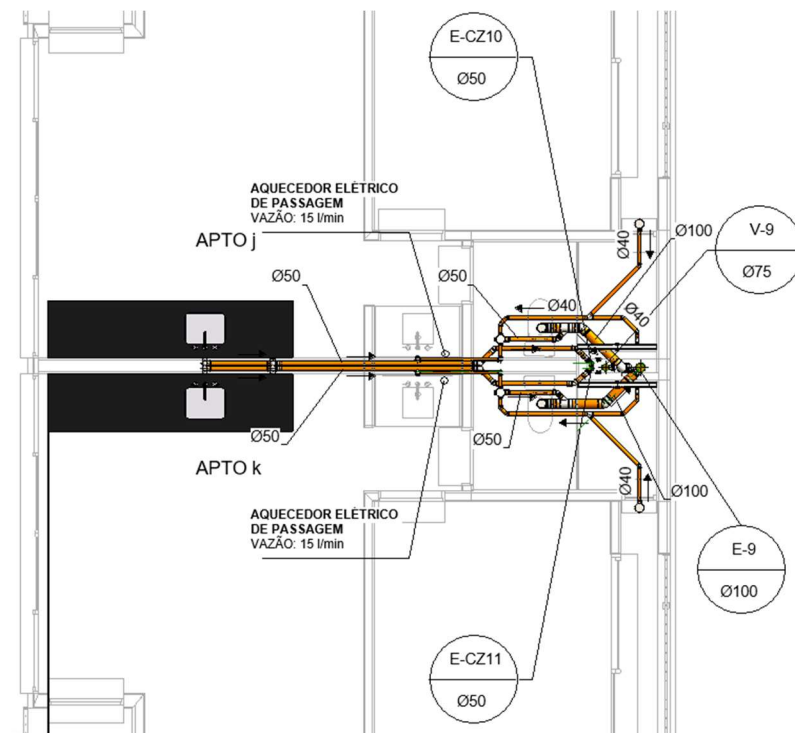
1º Pavimento – Ampliação 1 dos apartamentos J e K.
